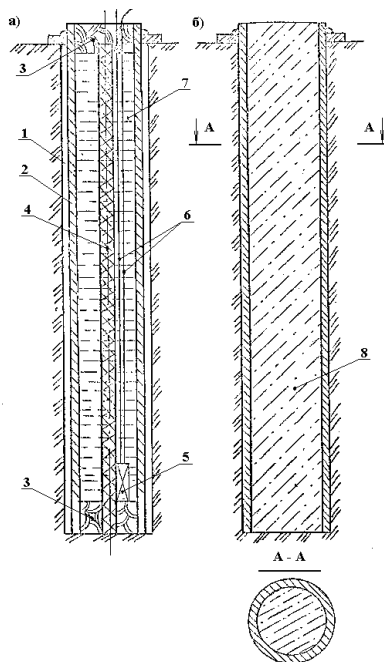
Конструкция снаряженной взрывчатým веществом трубной заготовки (а) и трубчатого анкера ТА2 (б): 1 – шпур; 2 – трубная заготовка; 3 – глиняная пробка; 4 – детонирующий шнур ДША или ДШВ; 5 – электродетонатор; 6 – электропровода; 7 – наполнитель (песок, вода); 8 – расширяющийся при твердении раствор
